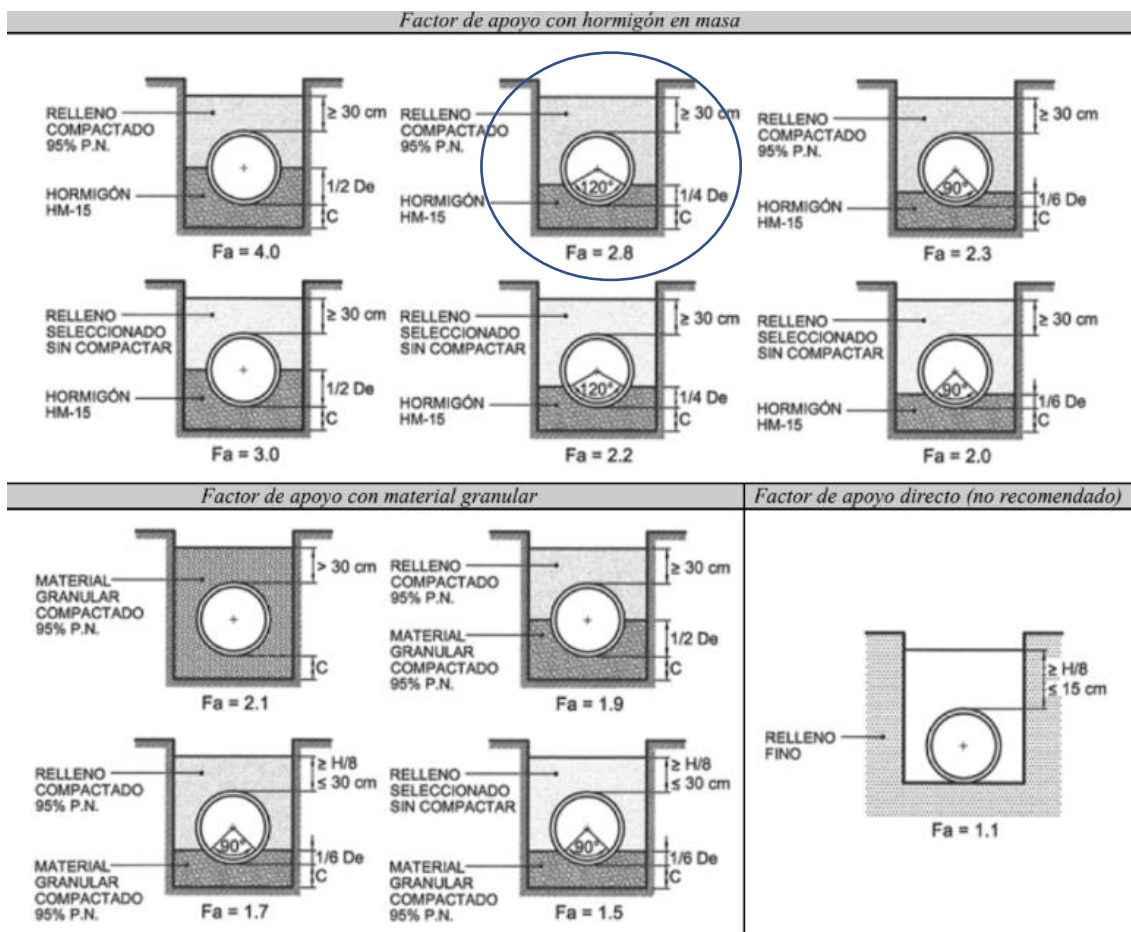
Factor de apoyo del hormigón en masa para conducciones de hormigón en zanja.
